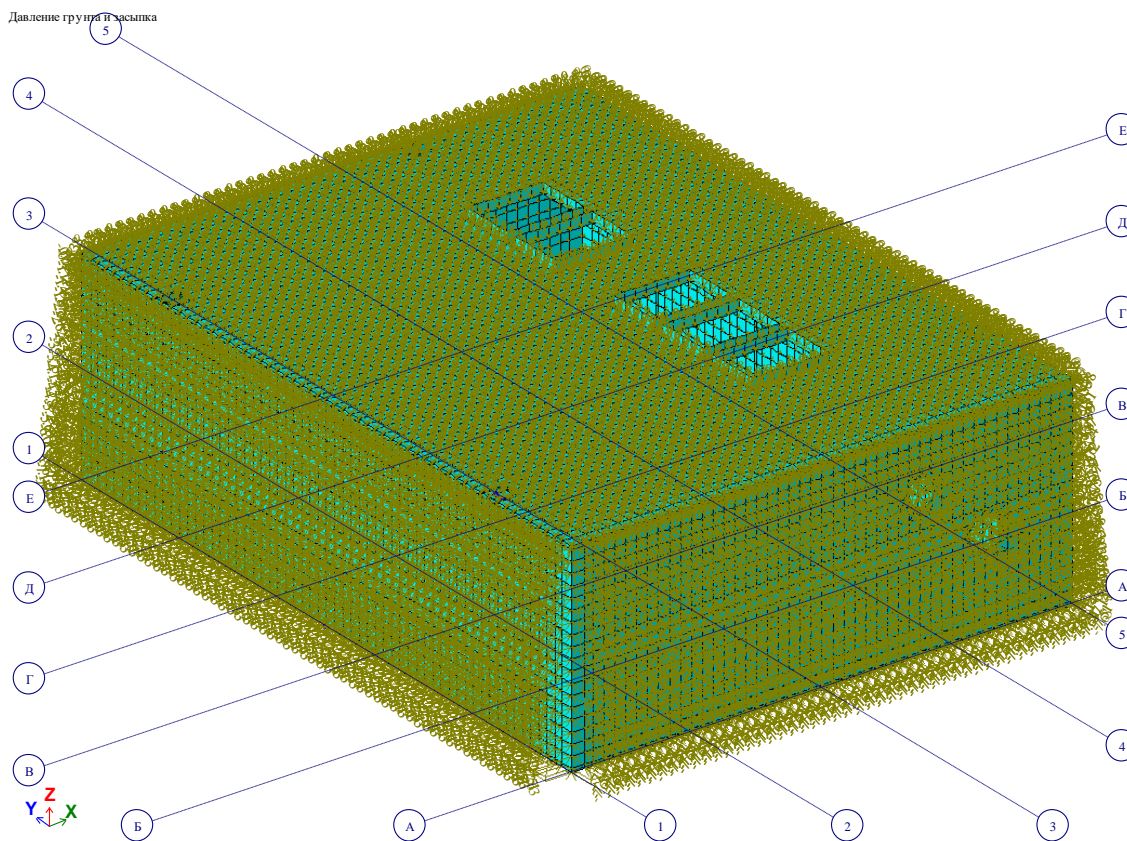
Нагрузки от бокового давления грунта и засыпки.
